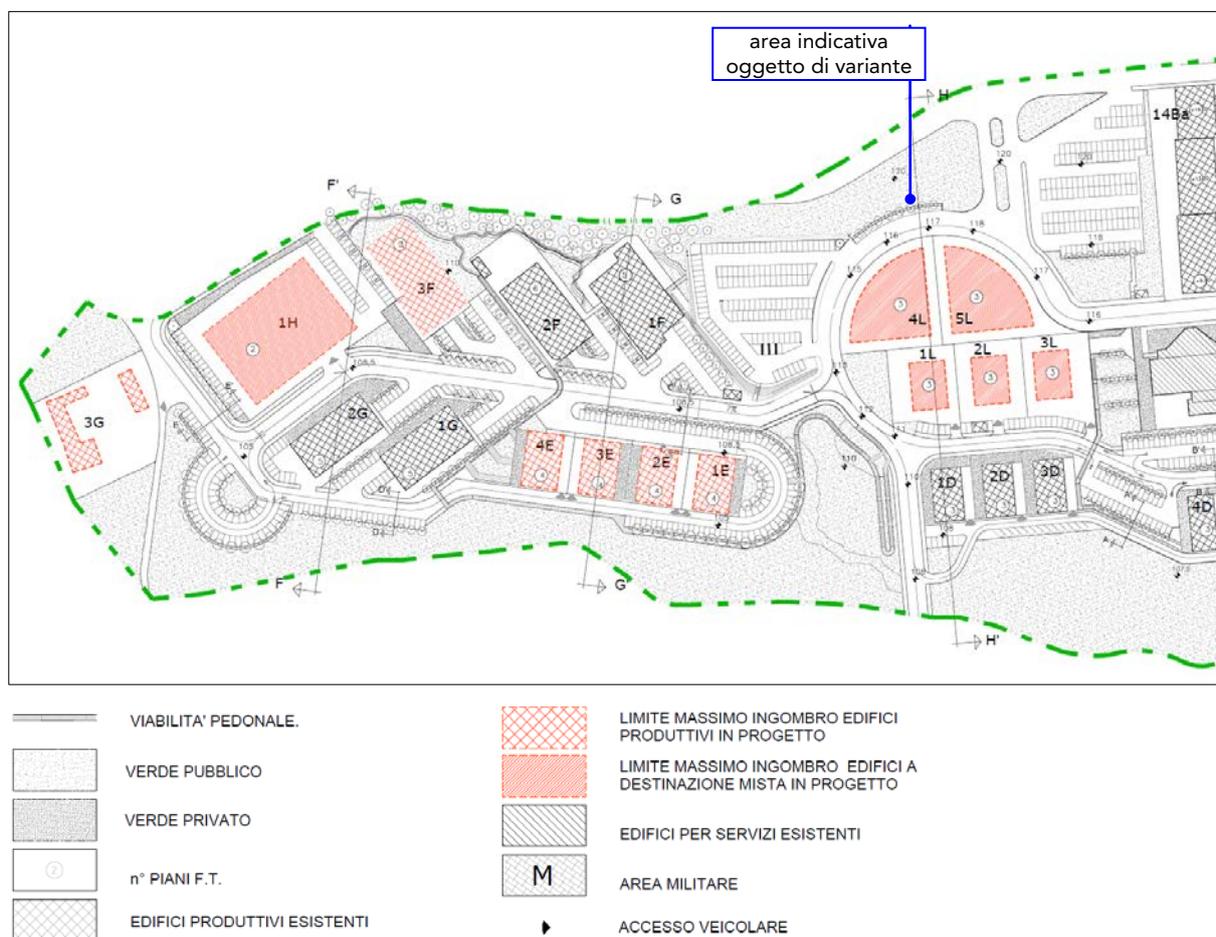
Estratto della Tavola 6 "Planimetria generale di progetto" della variante di completamento del PP Zona D2 approvata con DGC n. 83/2021.
